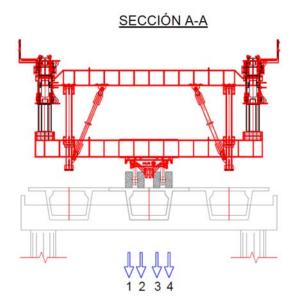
Carro de transporte sobre las vigas. Cargas debidas al trasporte de la viga lanzadora
